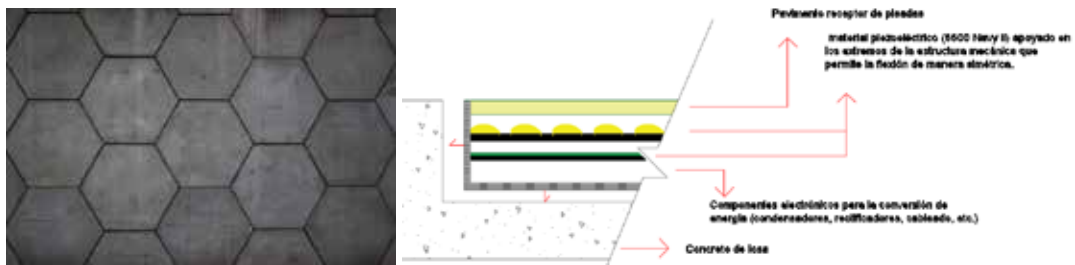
Revestimiento para exteriores Concreto estampado con Láminas piezoeléctricas. (2017)
